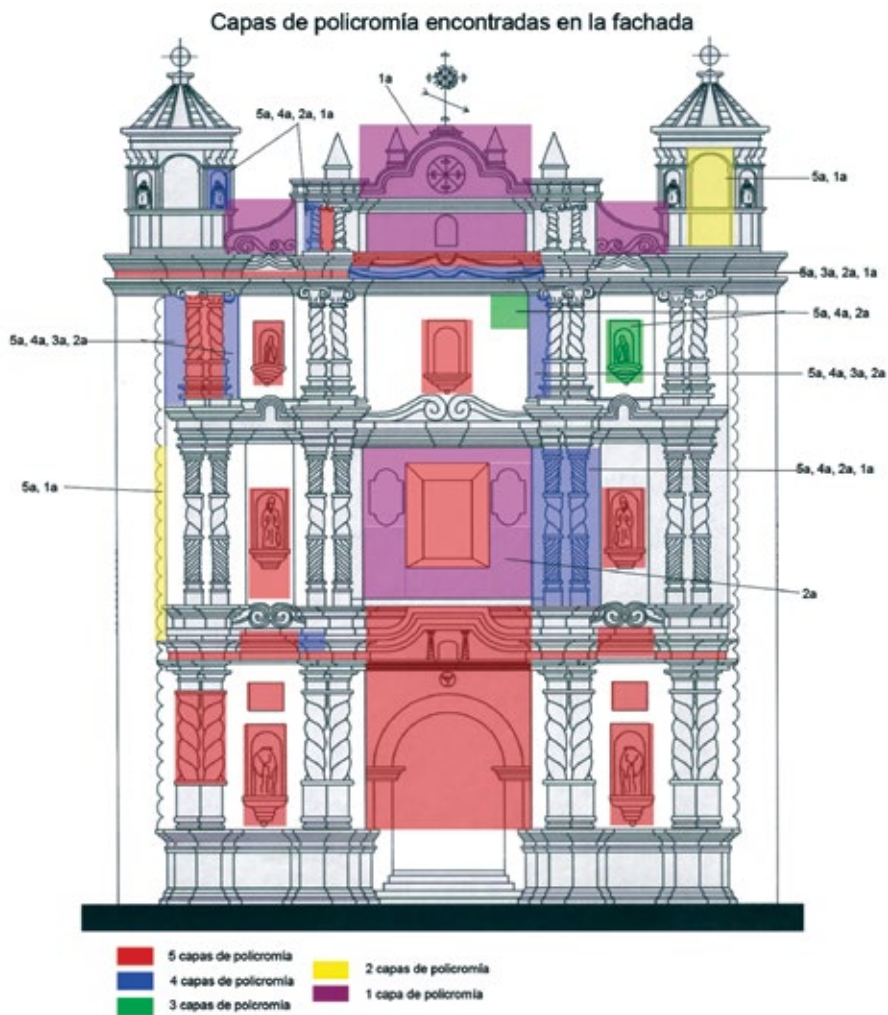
Capas de color encontradas en la fachada (Fuente: Orea Magaña 2007).
